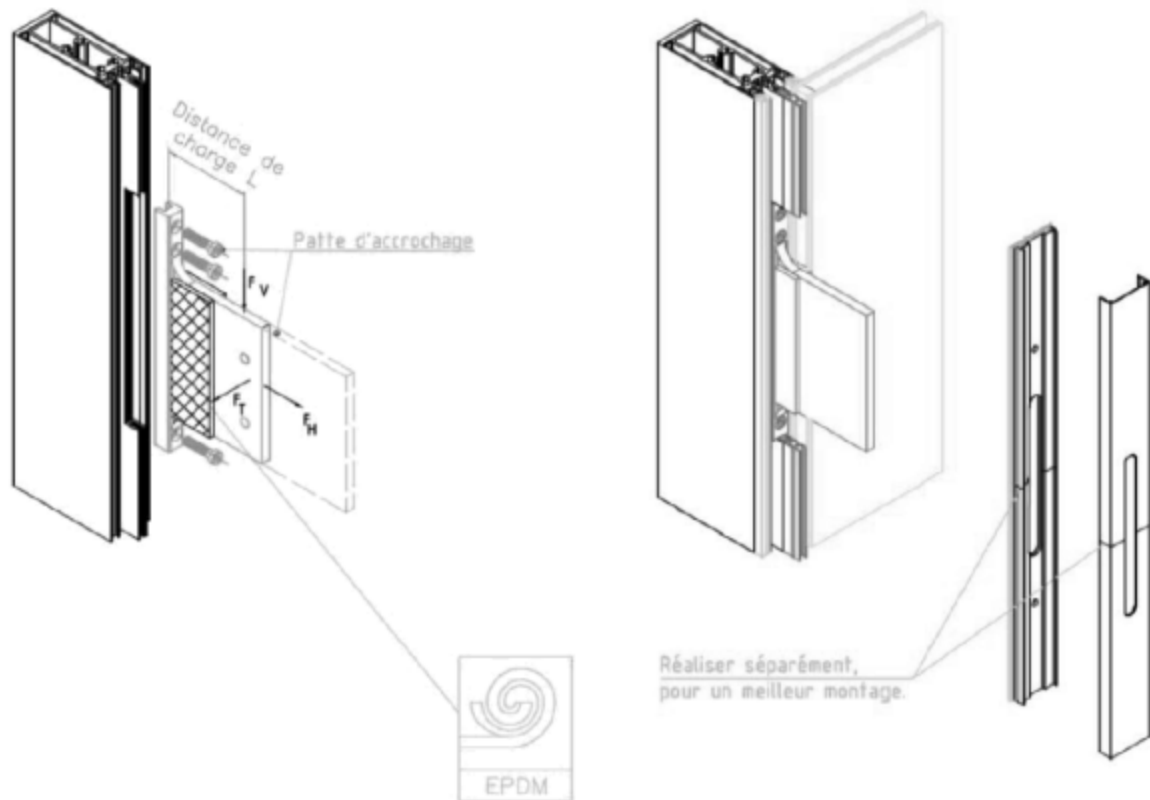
Pose devant mur rideau – Baguettes avec fixation par platine
